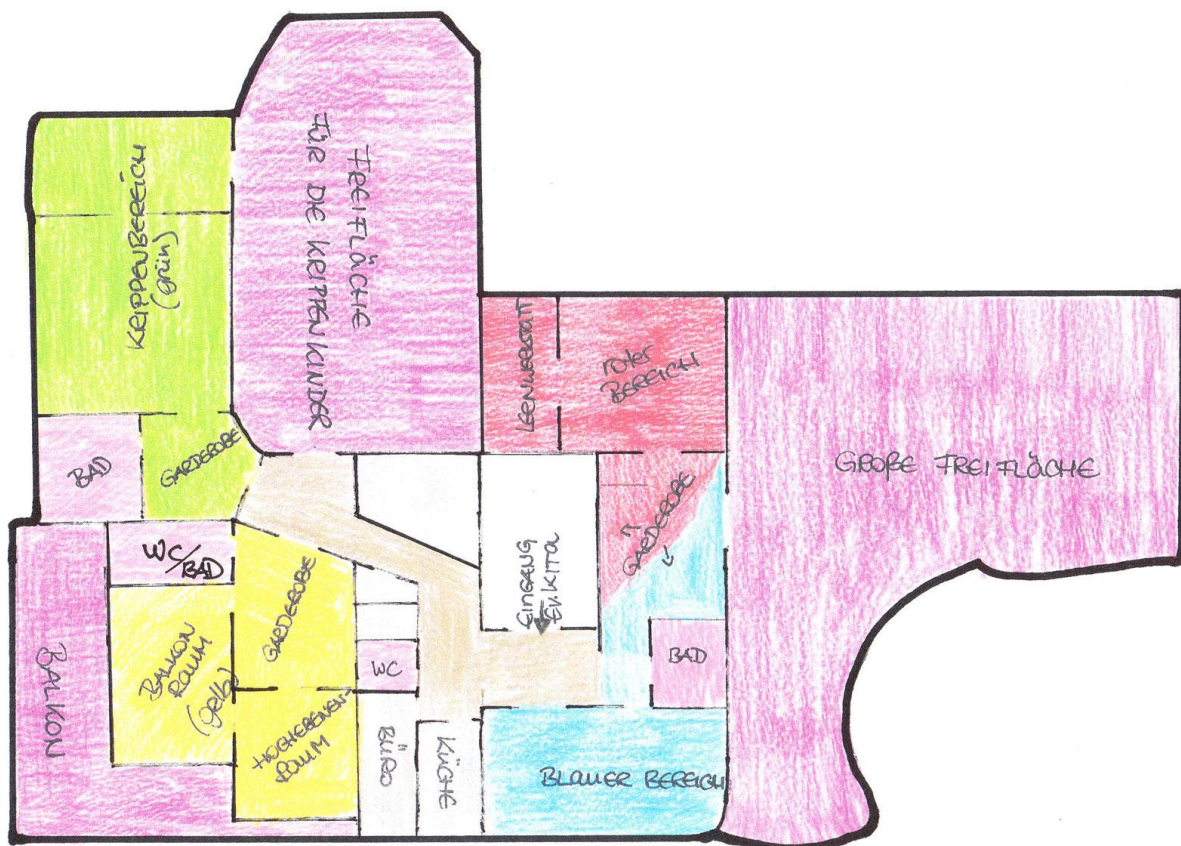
Grundriss/Lageplan der Räume und Außenspielflächen
